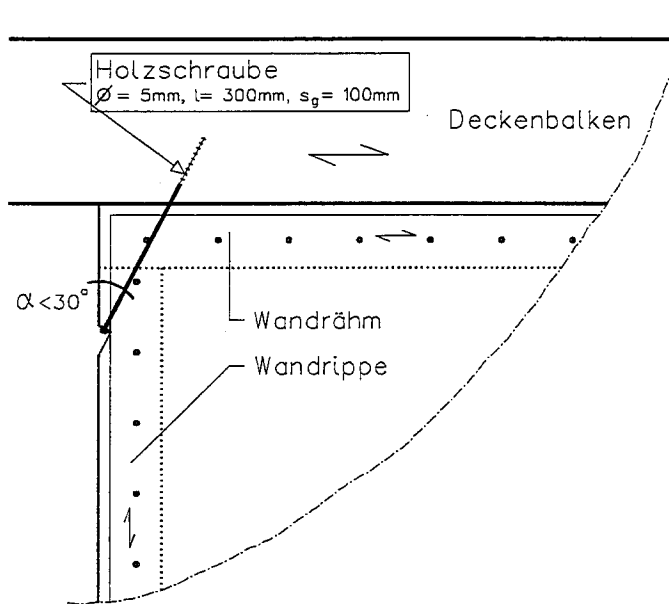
Anschlußvariante von Wandrandrippe an Deckenbalken
